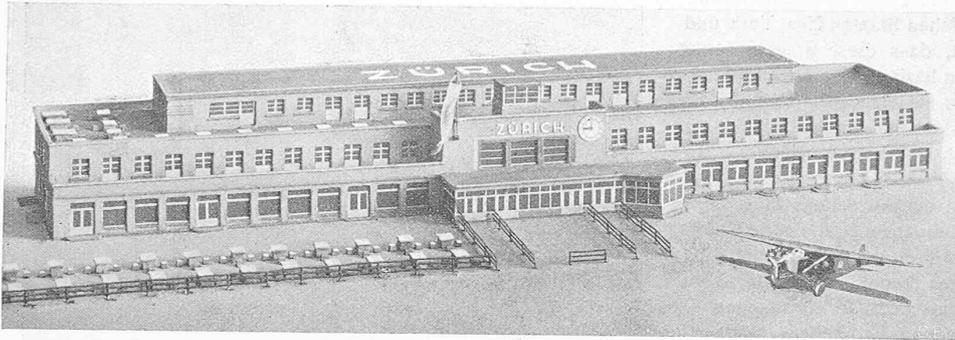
Modellbild des projektierten Stationsgebäudes (4 in untenstehendem Plan).
